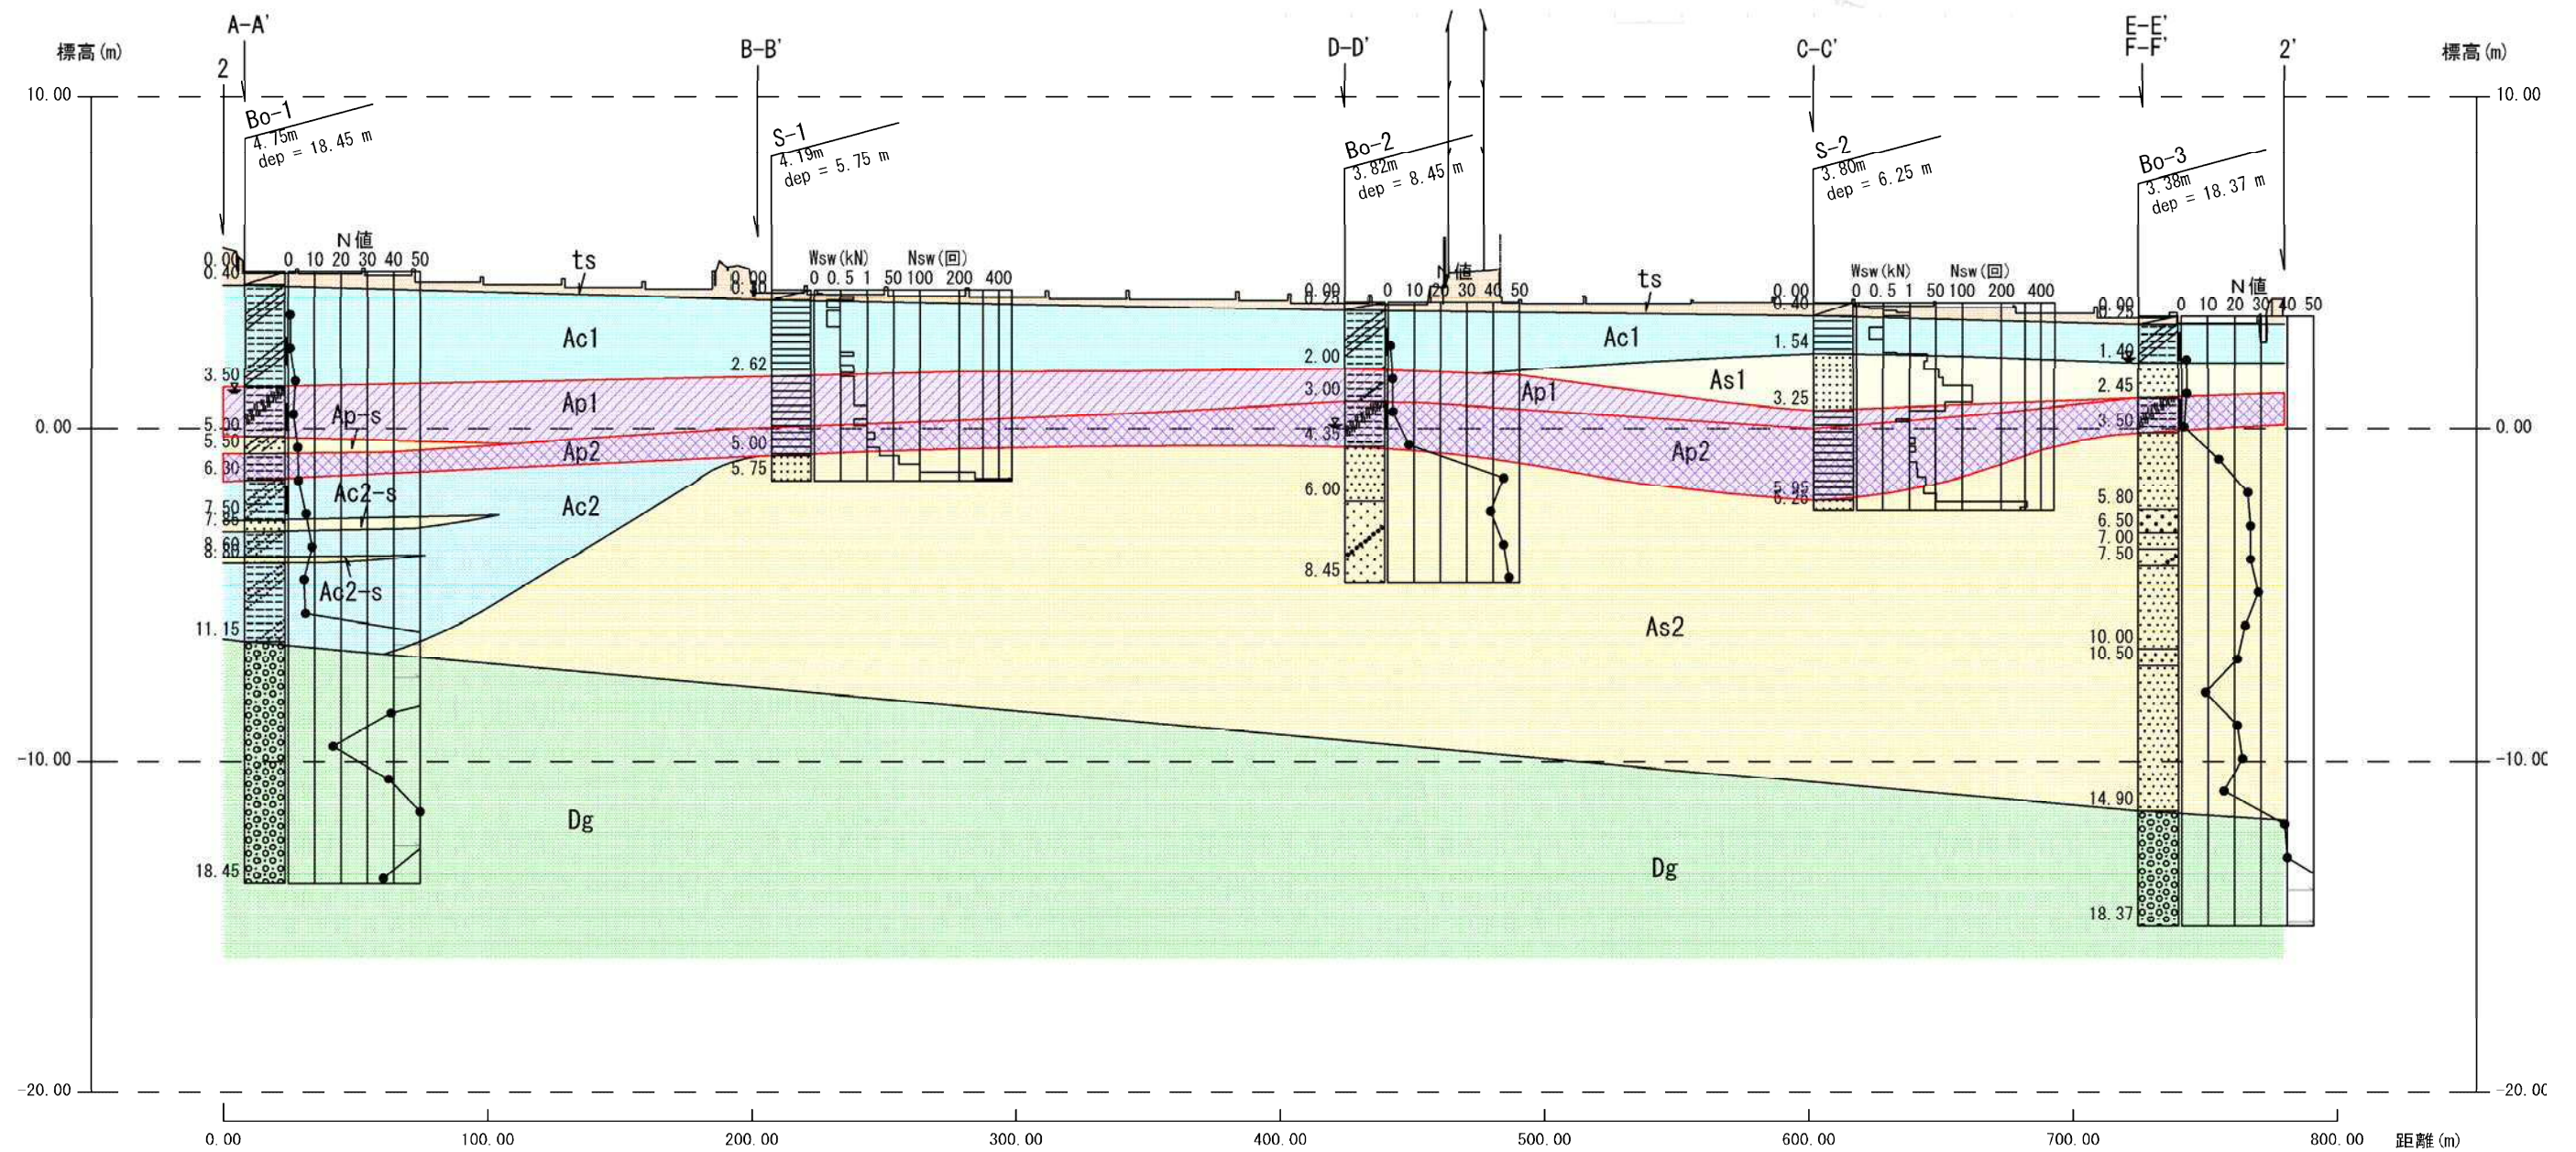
(2) 地層想定断面図 (2-2'、縮小版)
